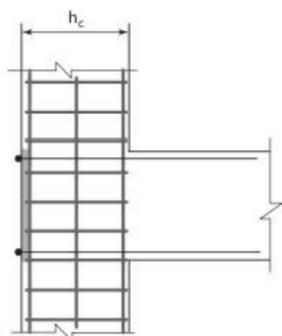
Nœud poteau-poutre de rive – plaque d'ancrage soudée
